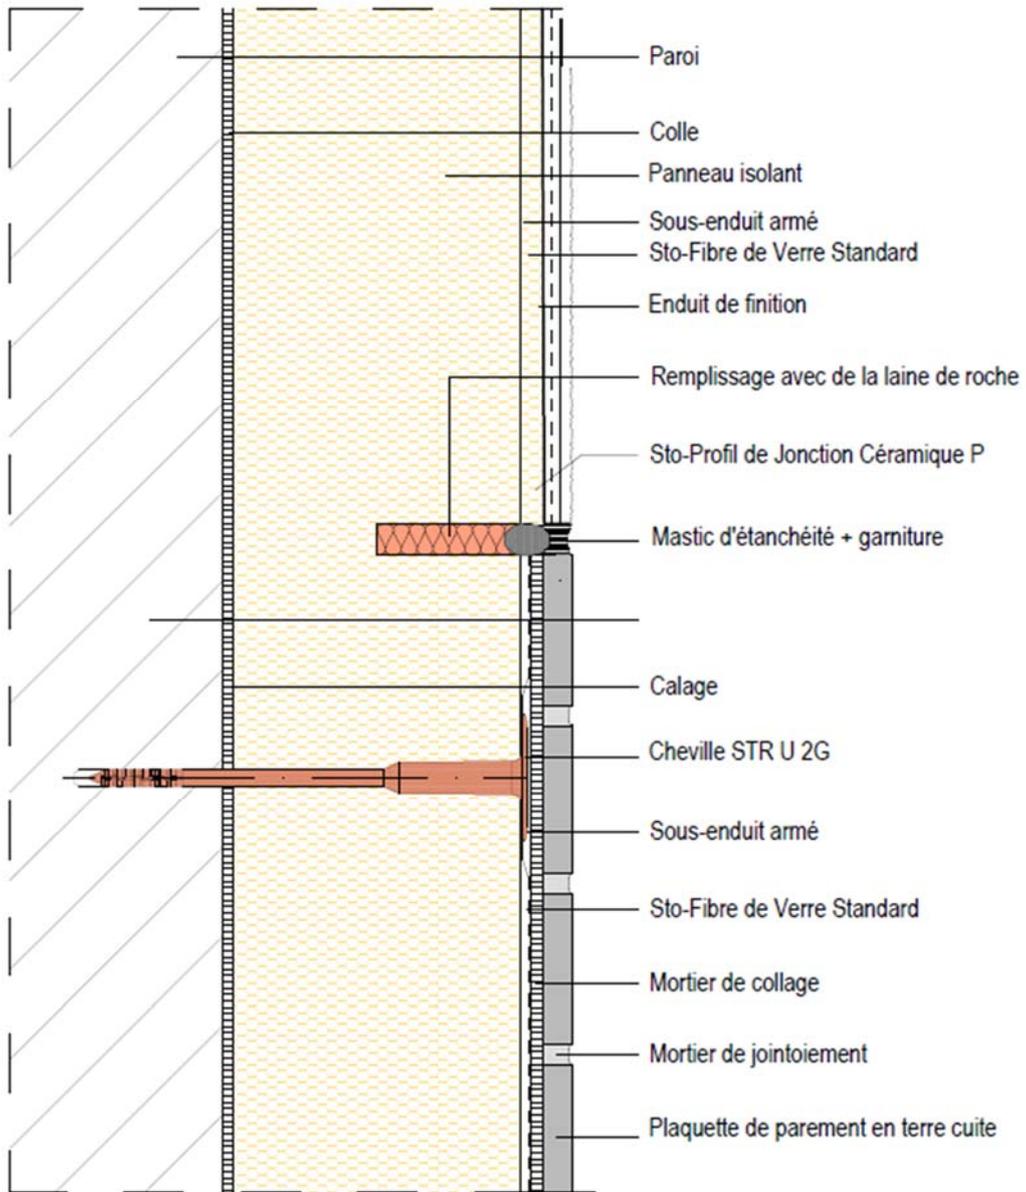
Raccordement entre finition par plaquette en terre cuite et finition par enduit – découpe de l'isolant
